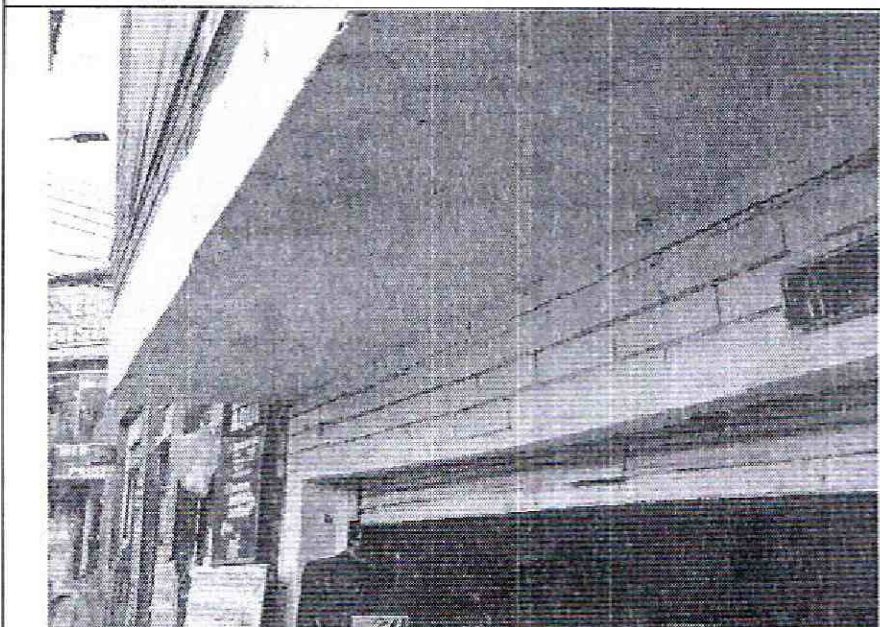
Dintel puerta local primer piso. Agrietamiento horizontal siguiendo el mortero de pega de los mampuestos. Se aprecia además deflexión del elemento.
